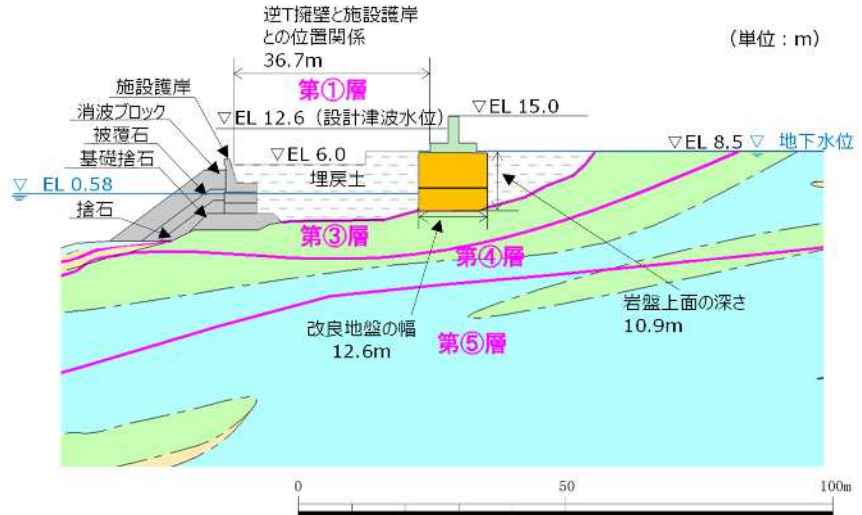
防波壁（逆T擁壁）の横断面図（①-①断面）
